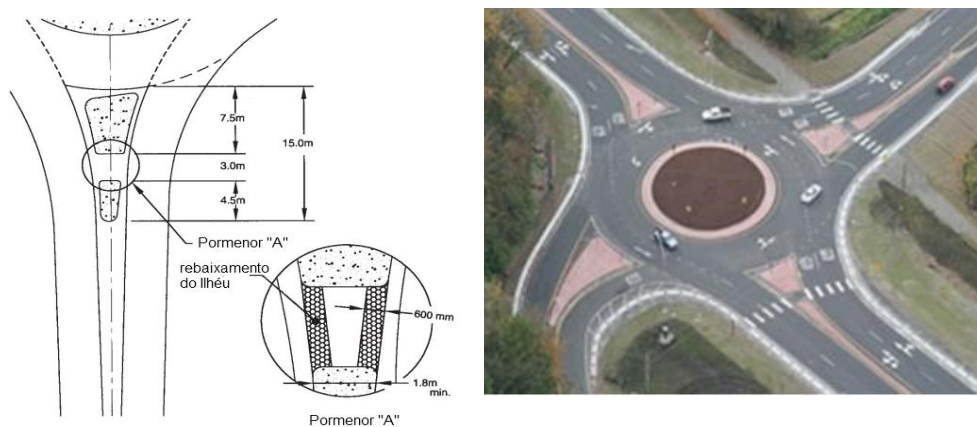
Pormenor do rebaixamento do ilhéu [Department Of Transport, 1993]
